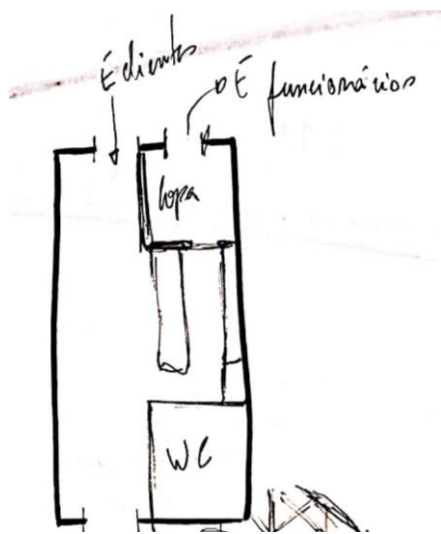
Estudo da planta da cafeteria, com colocação da copa junto a uma porta para o exterior
